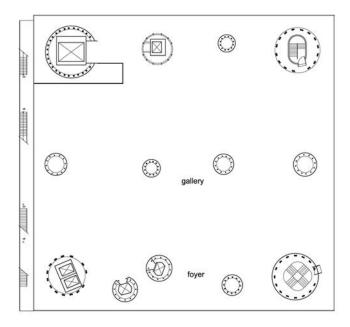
Planta 6to. Nivel, Mediateca de Sendai.
